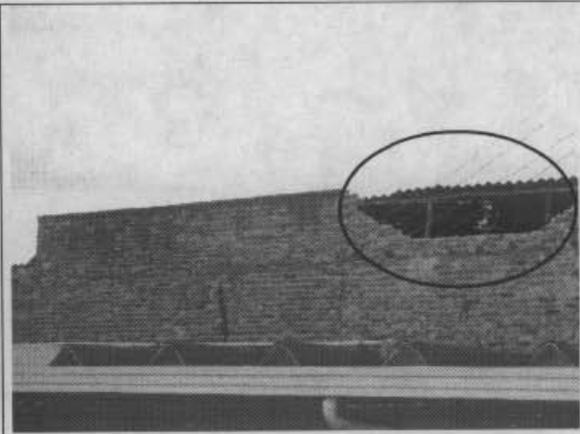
Condiciones de fachada sur. Desprendimiento de muros contra las edificaciones vecinas.
